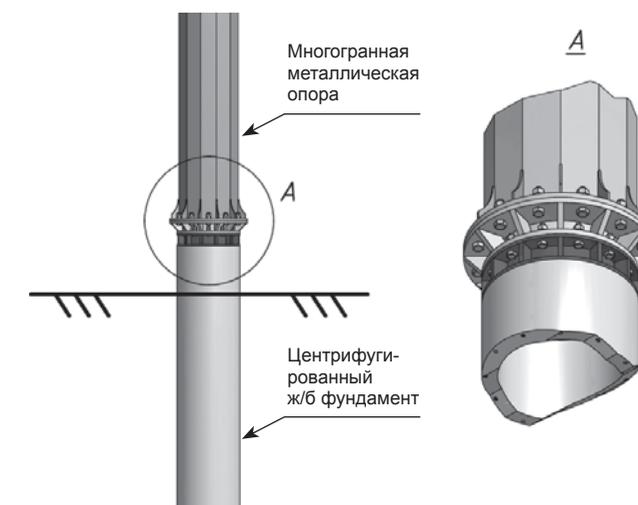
Схема железобетонного фундамента из центрифугированных предварительно напряженных секций диаметром 800 мм, имеющего металлический фланец для соединения с опорой (многогранной или железобетонной)
